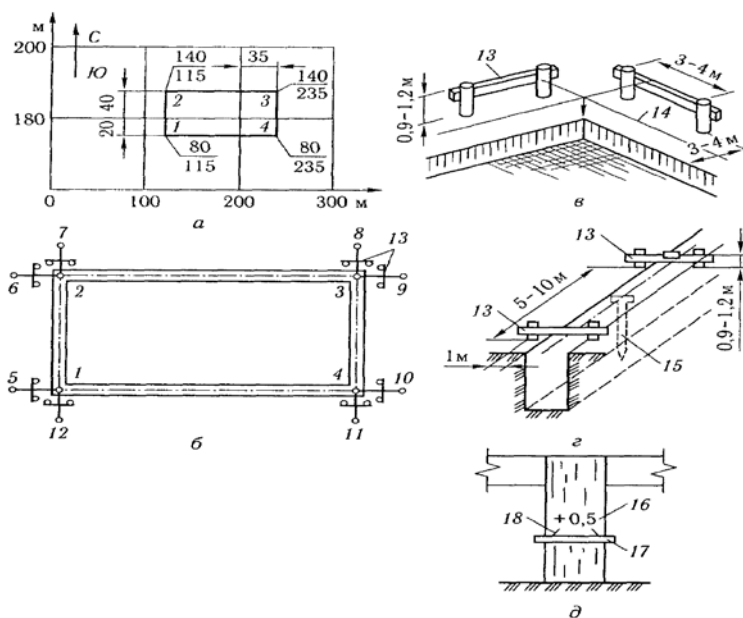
Розбивка котлованів і траншей: а – прив'язування будівлі до геодезичної будівельної сітки; б – закріплення осей будівлі на місцевості; в – розбивання котловану
